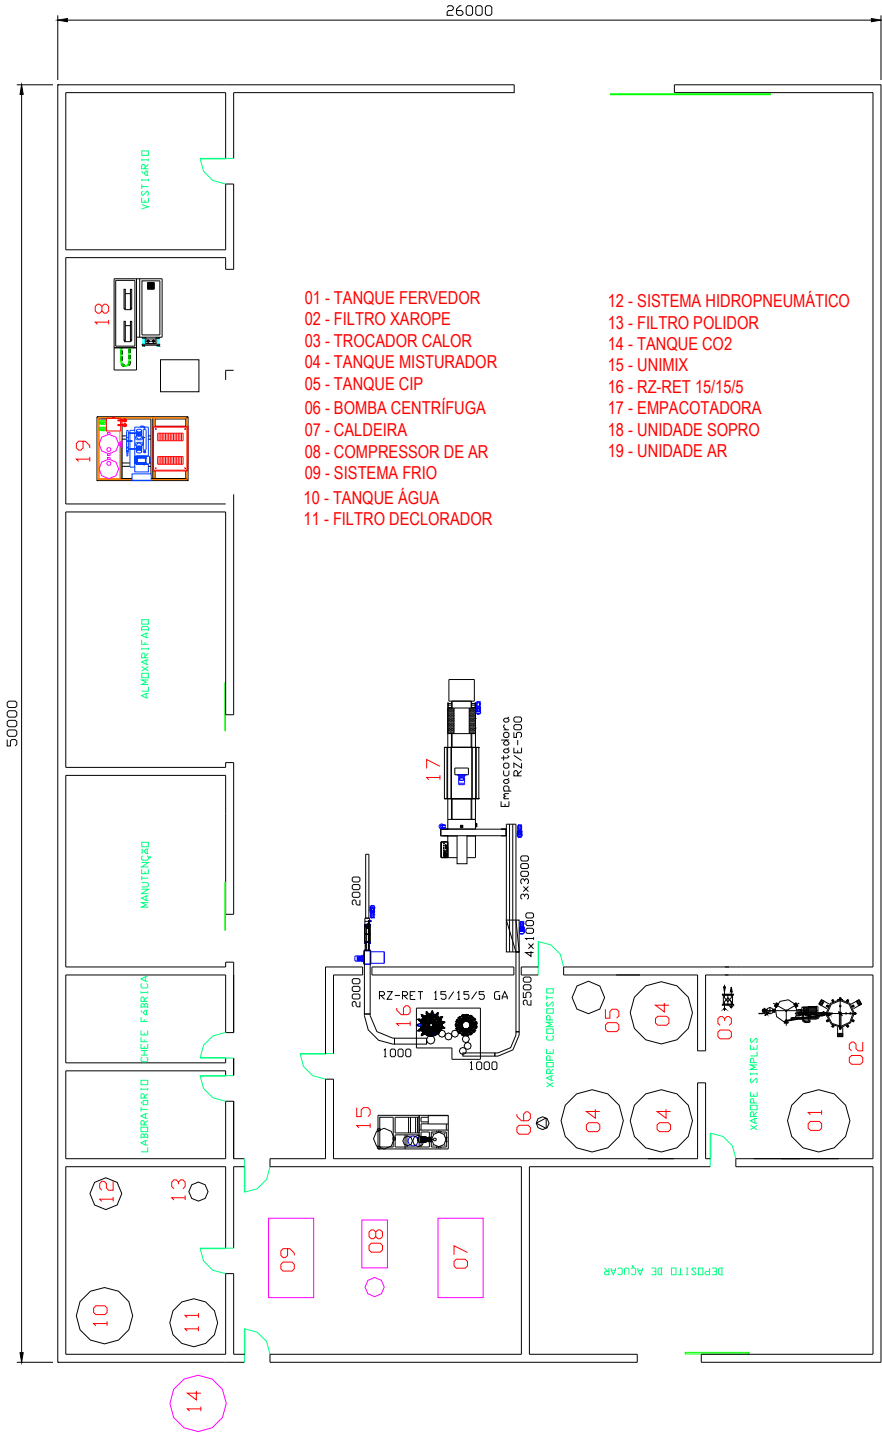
Planta do prédio de 1.300 m² com linha de produção instalada.
